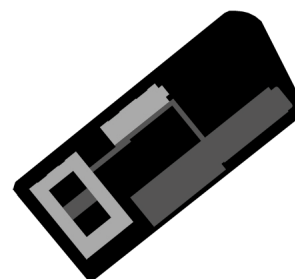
Esquema da planta de implantação da Escola Secundária Tomás Cabreira, em Faro.
